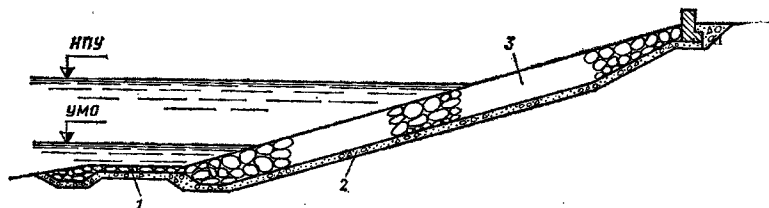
Пример конструкции откосного крепления из каменной наброски на однослойной подготовке 1 — облегченное крепление; 2 — подготовка однослойная; 3 — основное покрытие из камня
